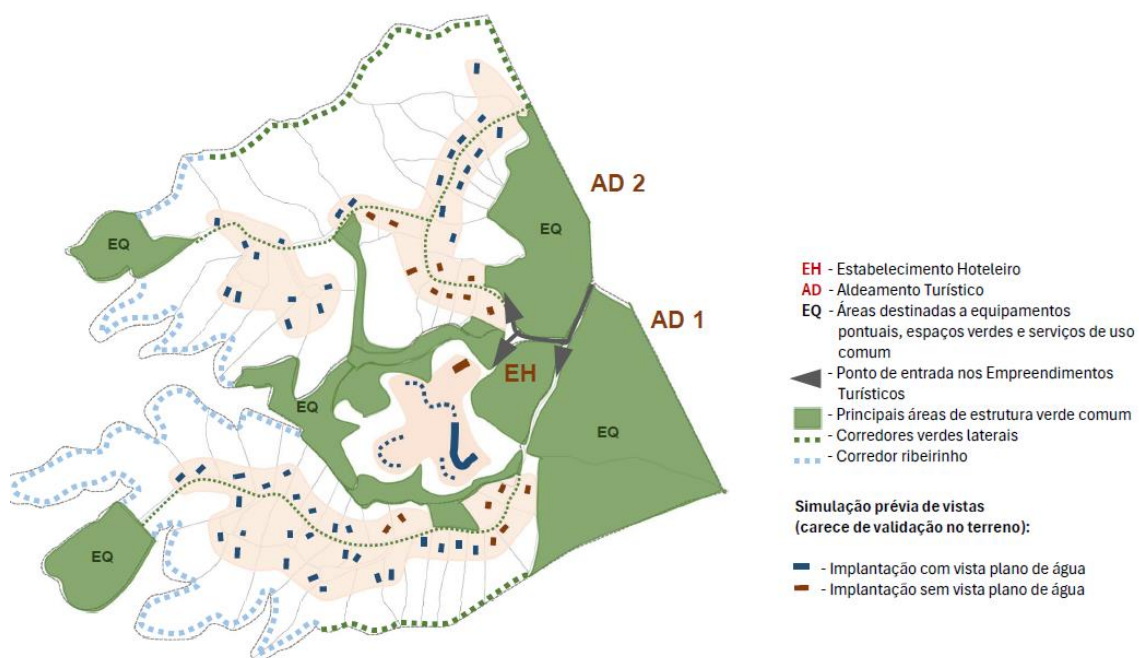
Esboço da Planta de Implantação do PIERHDC
